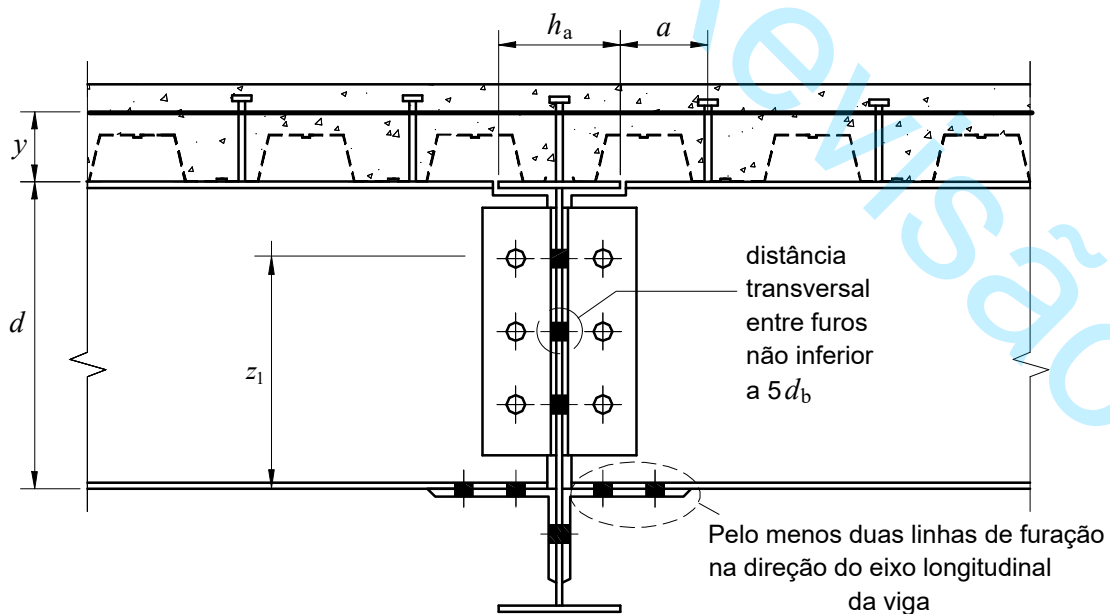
Ligação mista com cantoneiras parafusadas na alma (duas por viga) e na mesa inferior da viga apoiada
